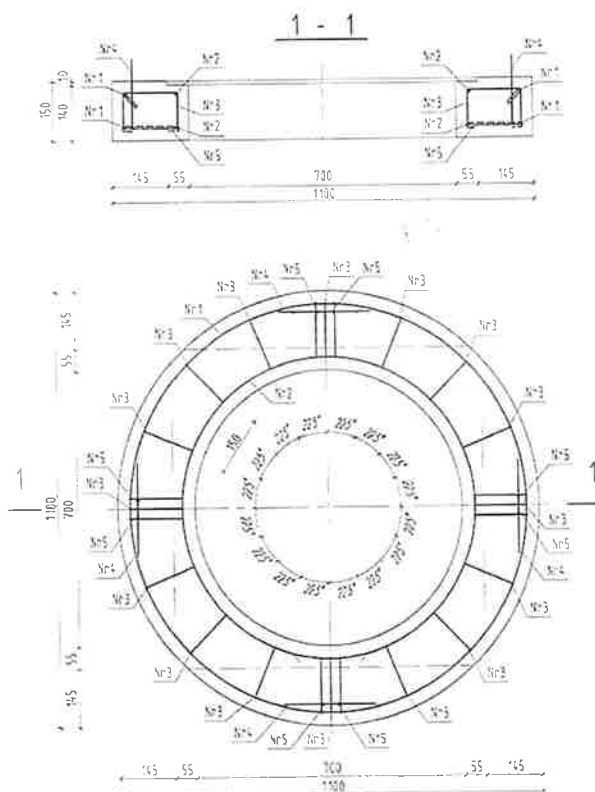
Stożek żelbetowy (SŻ)
